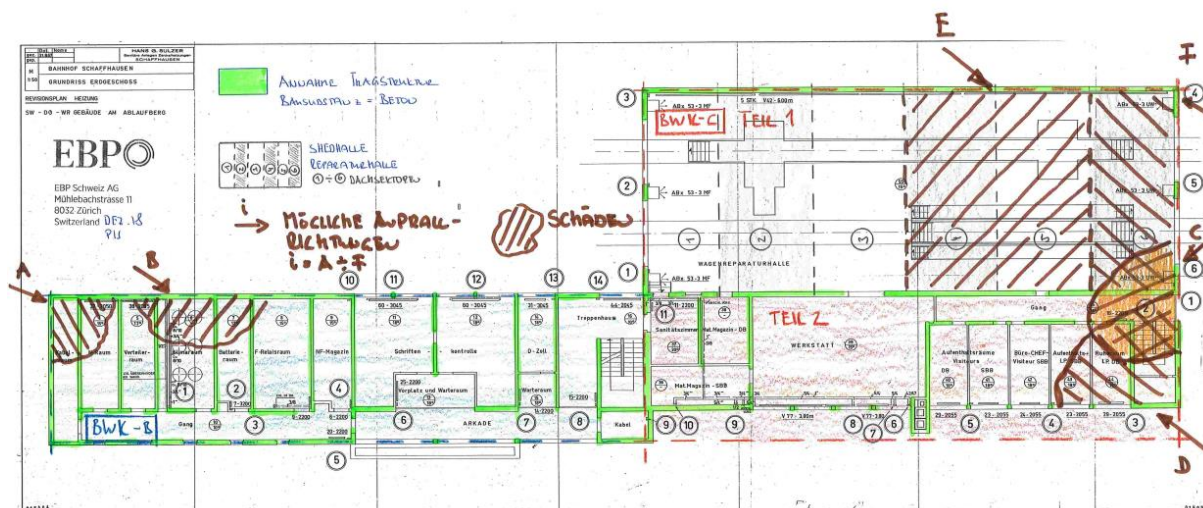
Grundriss Erdgeschoss (EG) mit Tragstruktur inkl. beispielhaften Anprallszenarien⁵
